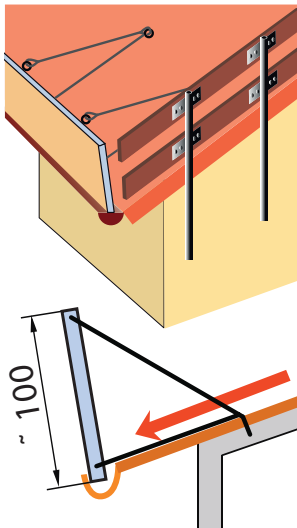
/309: Dachfangwand und Seitenschutz (oben)
